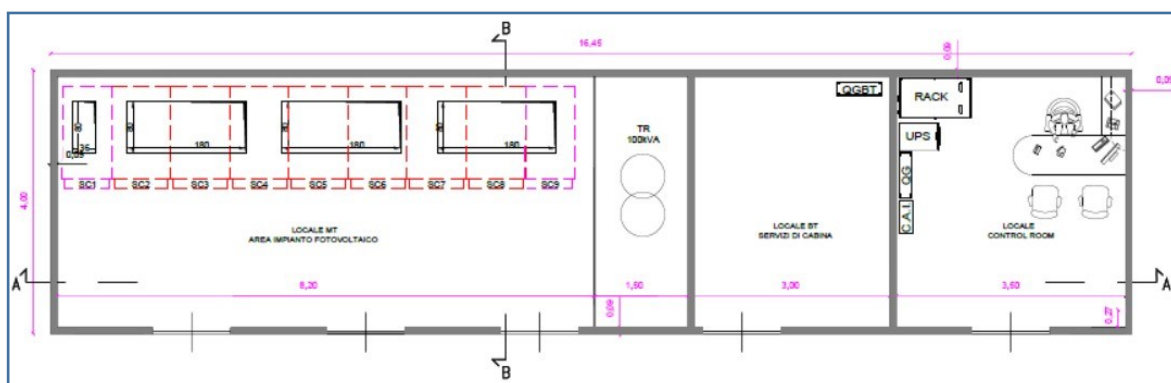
PIANTA CABINA ELETTRICA DI RICEZIONE E CONTROLLO
